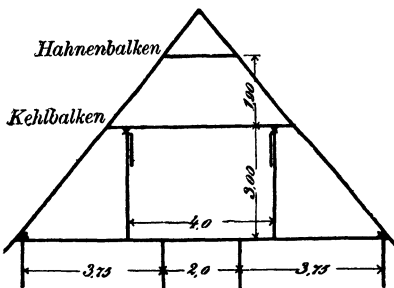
Kehlbalkendach mit doppelt stehendem Stuhl und Hahnenbalkenlage.
